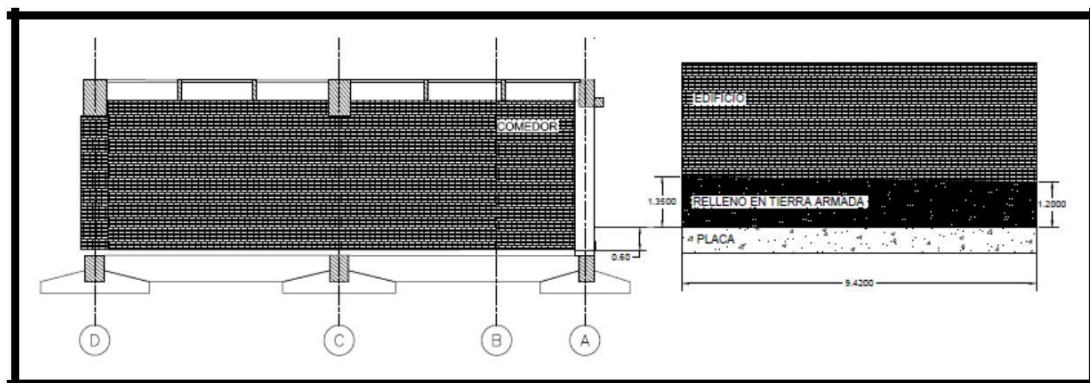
Corte Longitudinal - Zona Edificio Femenino
